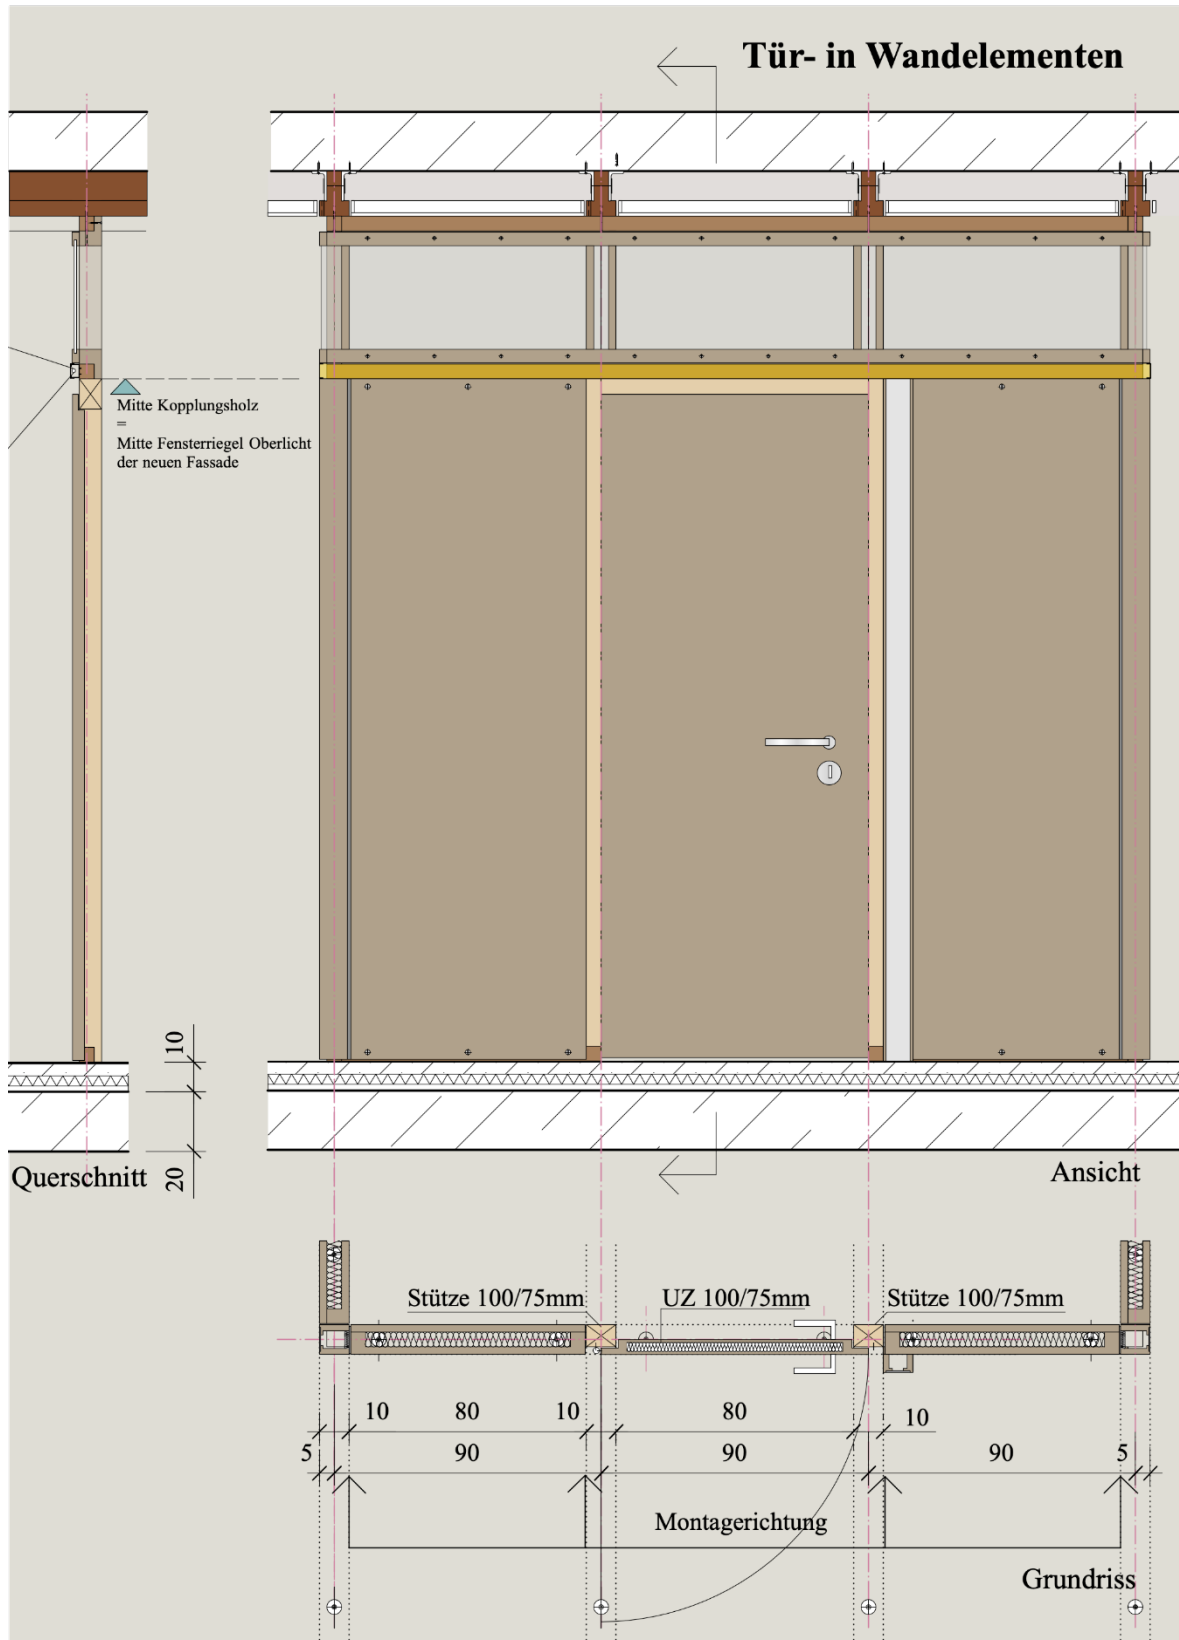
Darstellung Querschnitt/Ansicht/Grundriss - Einbau Drehtür in Wandelement
